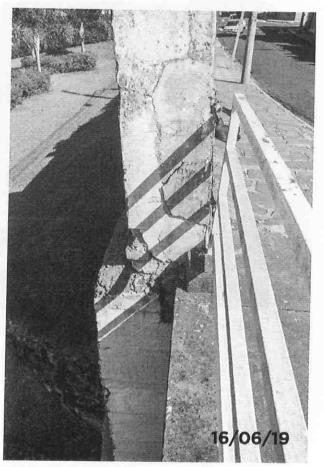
Detalhe do guarda corpo sem conexão com o muro e também apresentando corrosão.
